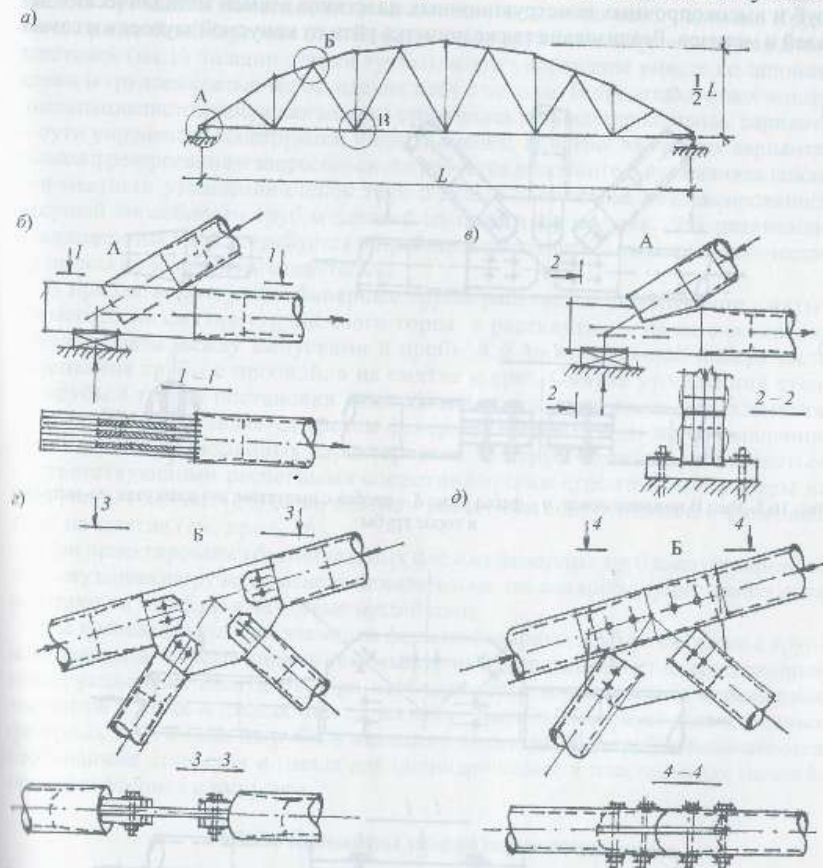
Ферма из фанерных труб с узлами на традиционных выпусках и фасонках из ДСП-В с болтами из стали, ДСП-В или стеклопластика АГ-4С: а – схема фермы; б – вариант опорного узла А с простым лобовым упором выпусков; в – узел А по типу лобовой врубки; г – узел В на выпусках и фасонке; д – узел В с лобовым упором пробок, с врезанной фасонкой для крепления решетки
